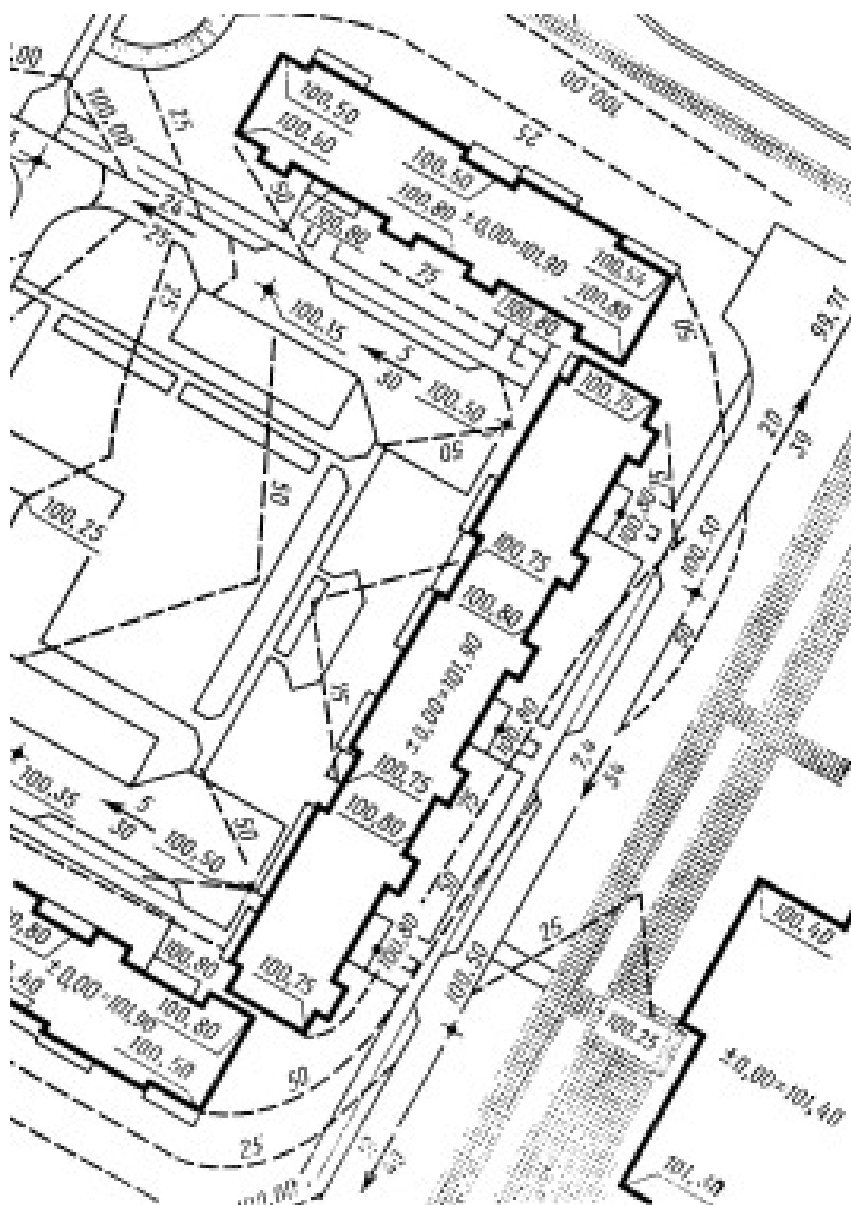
Фрагмент вертикального планування території житлової забудови
